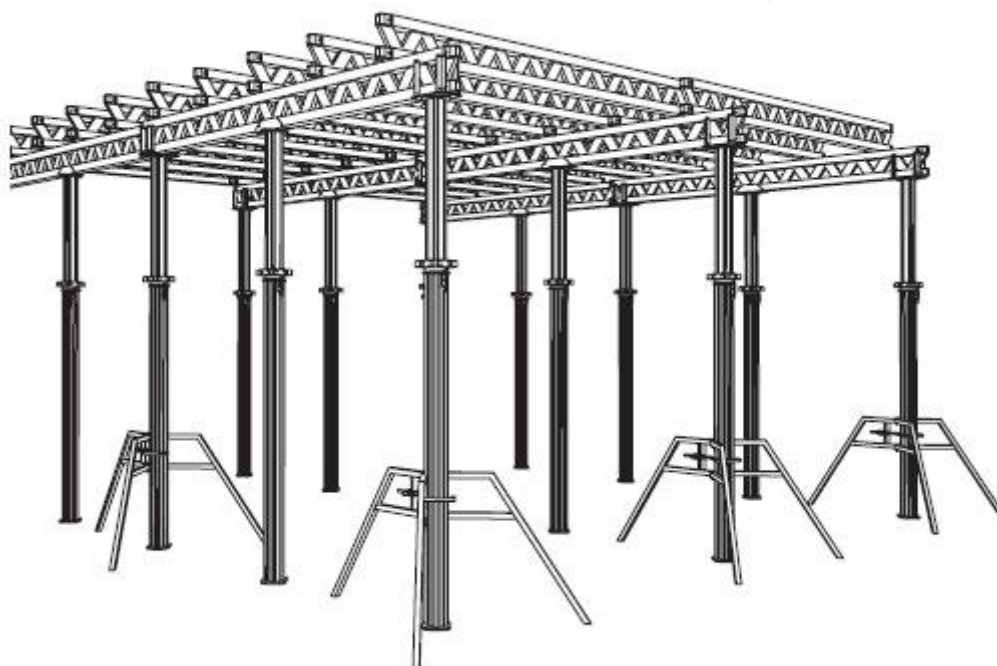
Sistema de Escoramento Duplamente Vigado MULTIFLEX da Empresa PERI [9]
